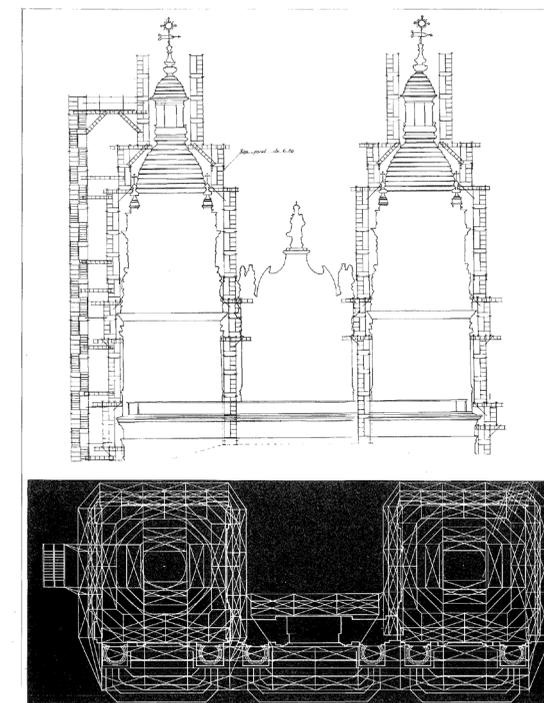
Planta y sección de la instalación de andamios en la fachada principal.
